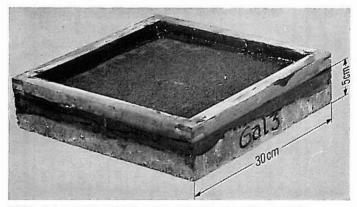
Gehwegplatte mit Rahmen zur Aufnahme einer Wasserschicht
